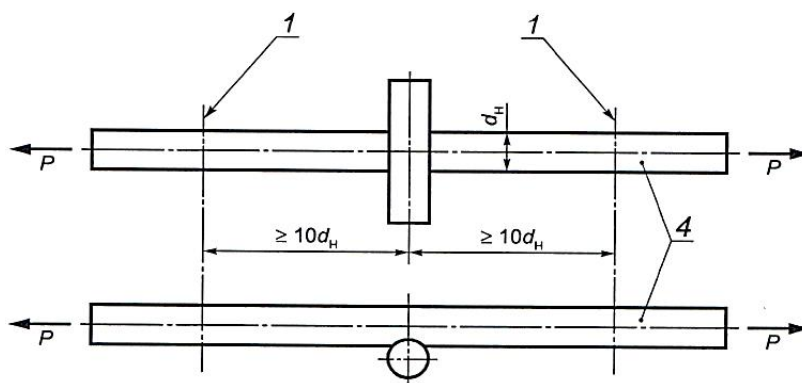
Схема испытания тавровых соединений анкерных стержней закладных изделий на отрыв: d_n – номинальный диаметр рабочей арматуры; P – испытательная нагрузка; 1 – граница закрепления в захватах разрывной машины; 2 – стержень рабочей арматуры
